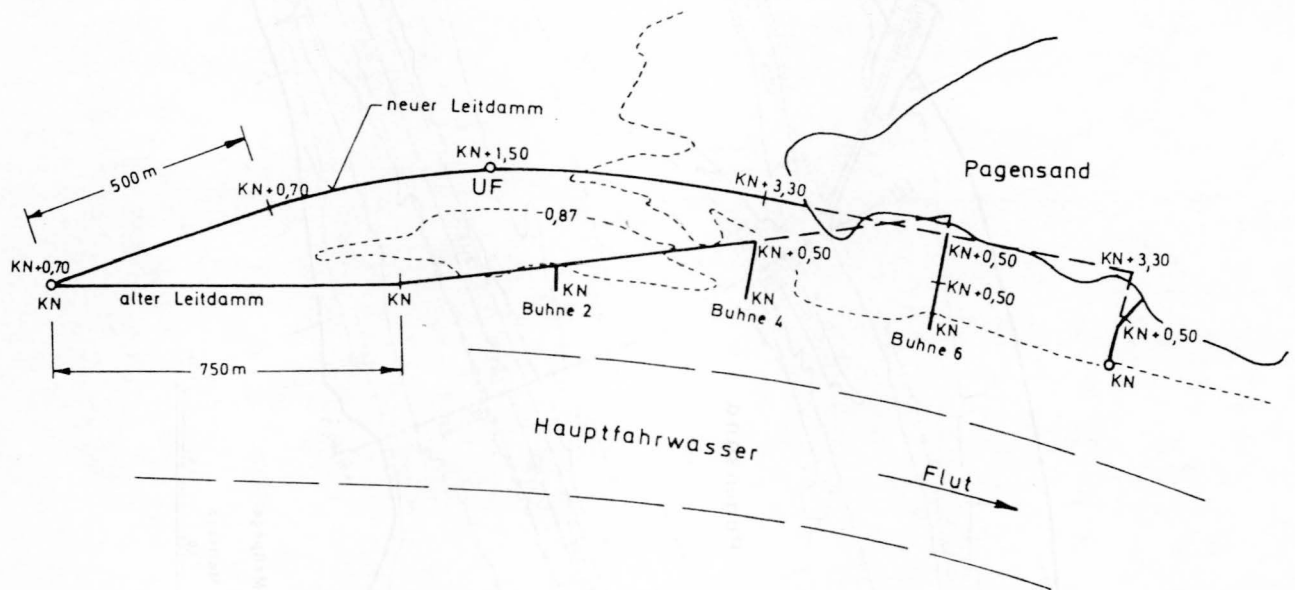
Lageplan der Leitdammvariante 9/1 (Ausführungsvorschlag)
